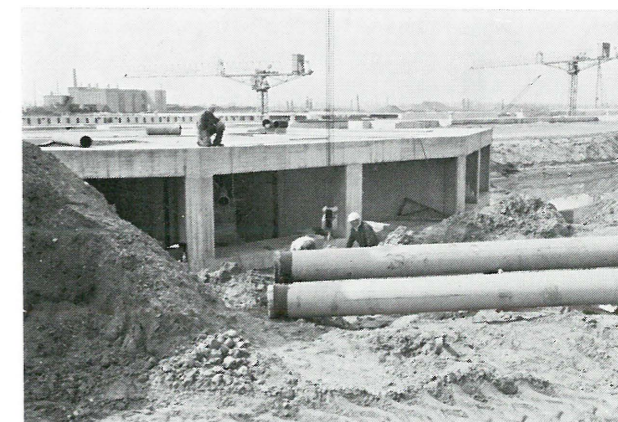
Uitmondung van de leidingentunnel op het sluisplateau.
